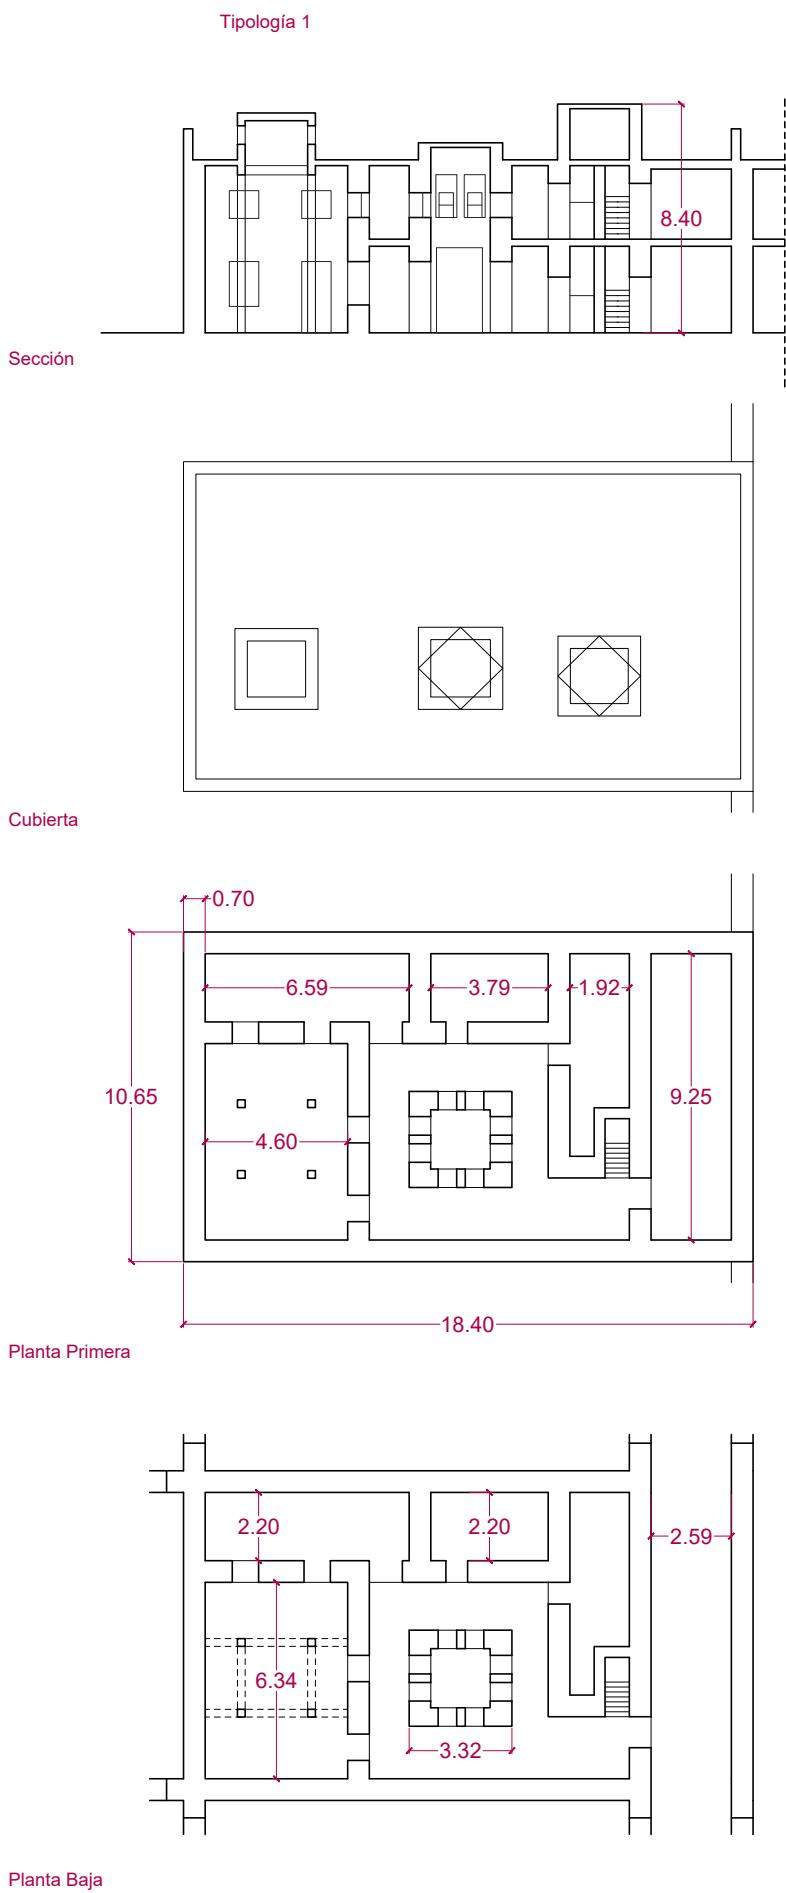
Planos Tipología 1 de vivienda. Elaboración propia con AutoCAD
